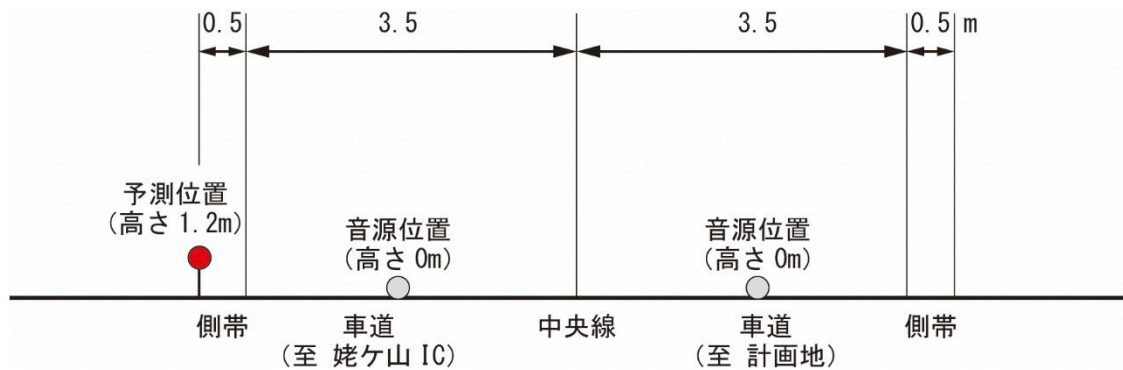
(2) 道路断面図 (No.2 : 嘉瀬蔵岡線沿道 (西側))
